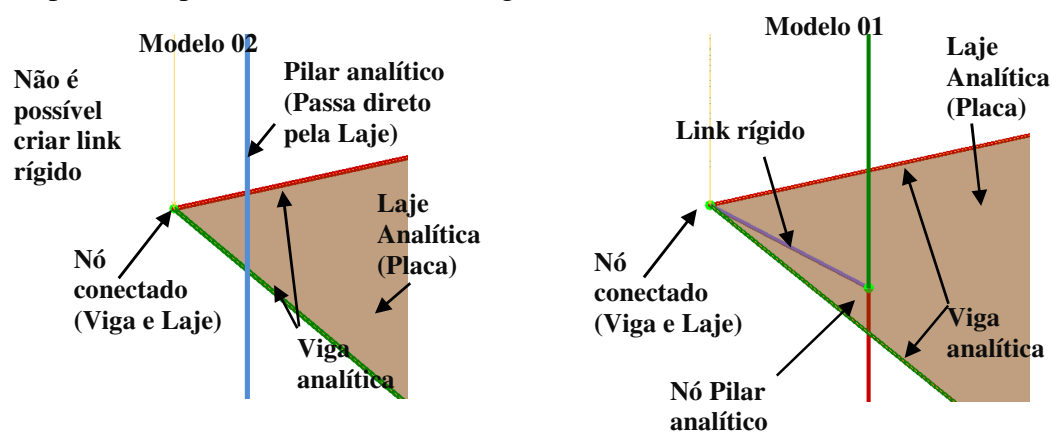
Exemplo III – Pilar seguindo direto no modelo 02
